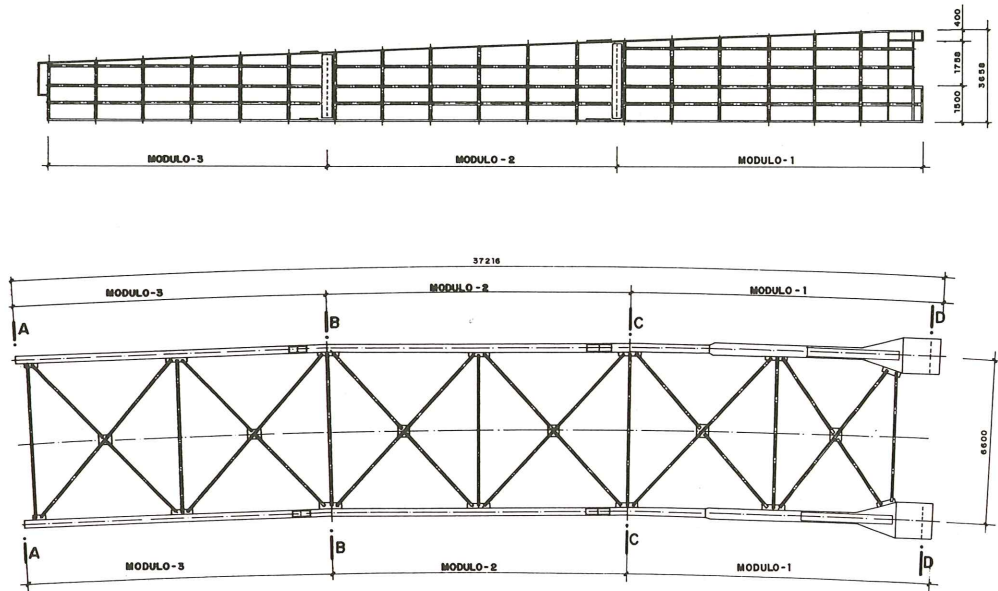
Alzado y planta de un pico, o nariz metálica, de avance.
